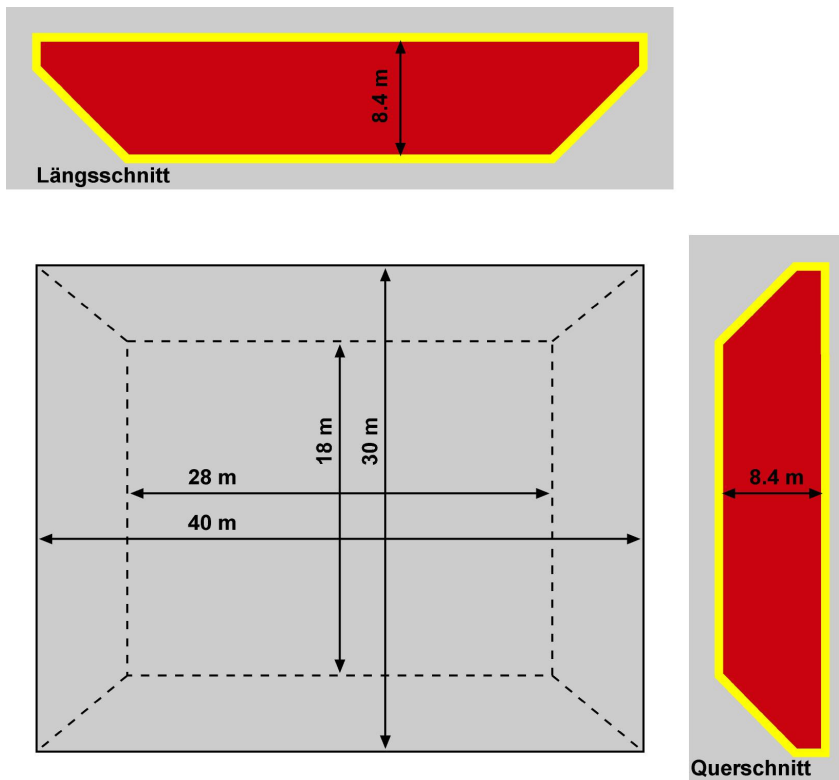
Grundriss Pufferspeicher und Zentrale Solaranlage
